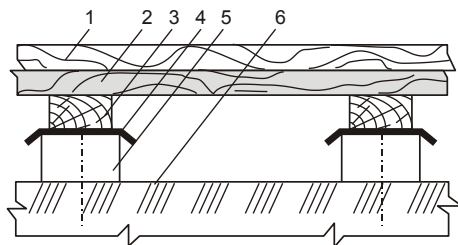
Конструкция пола из сверхтвердых древесно-волоконистых плит по дощатому основанию:
